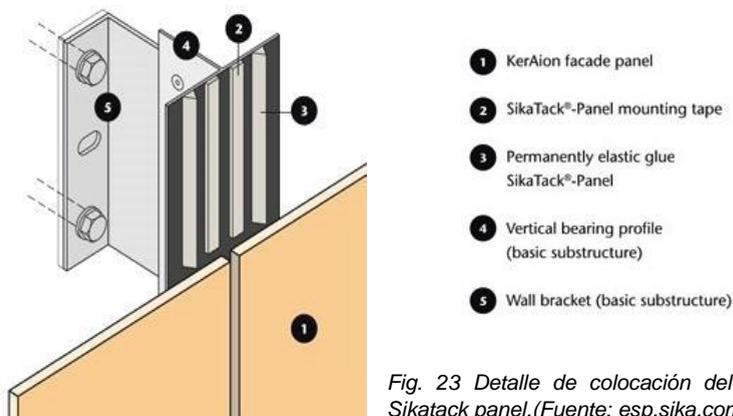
Detalle de colocación del sistema Sikatack panel. (Fuente: esp.sika.com)
